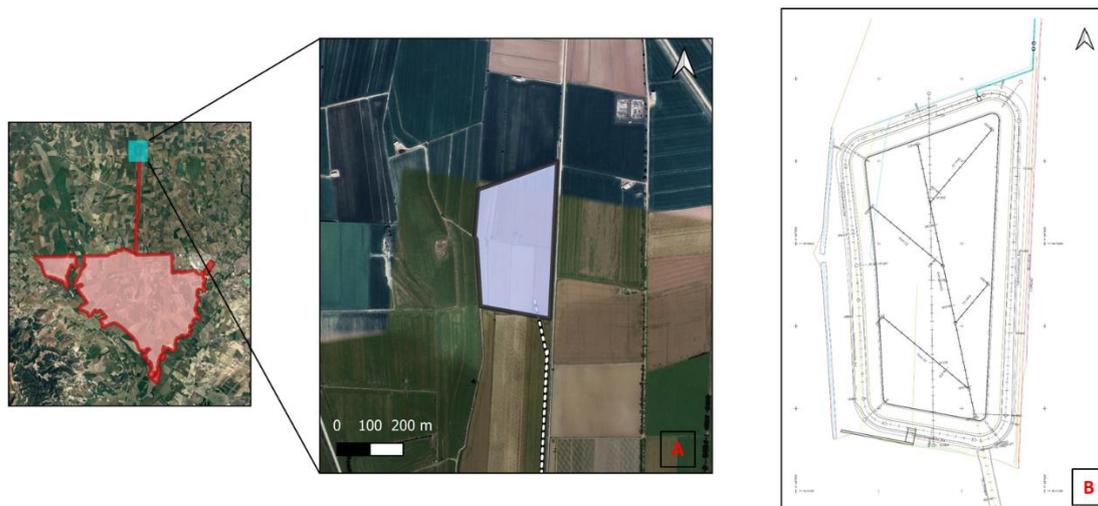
Ubicación (A) y planta general (B) de la balsa.
